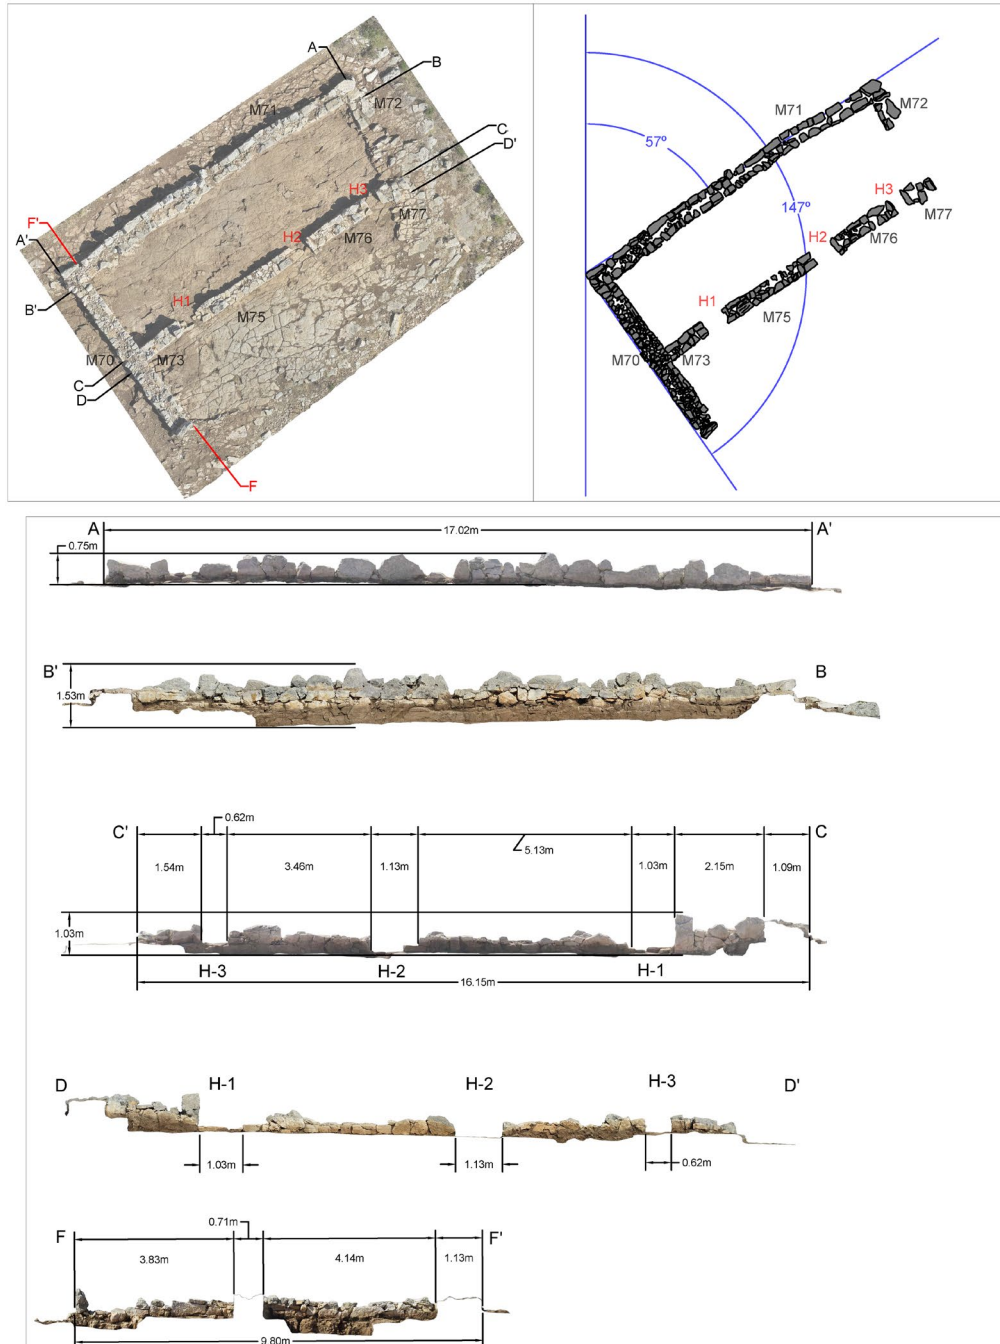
Planta de la mezquita con orientación general y secciones con alzados de los muros
